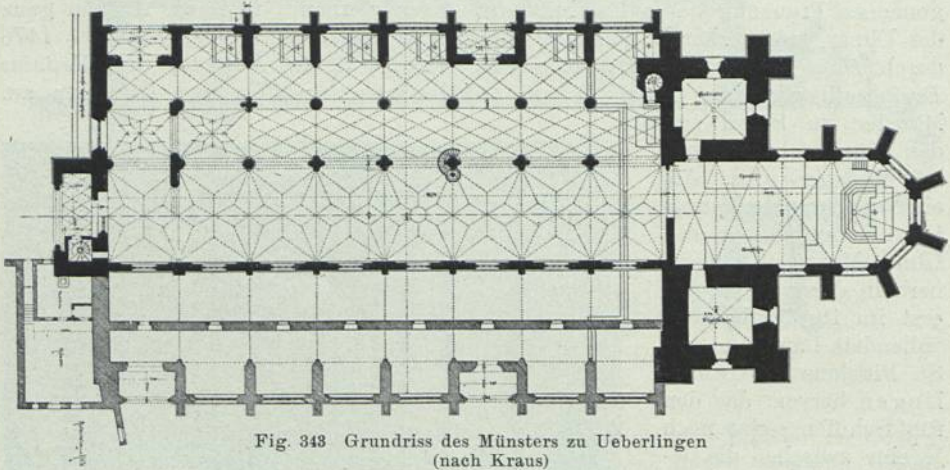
Grundriss des Münsters zu Ueberlingen
